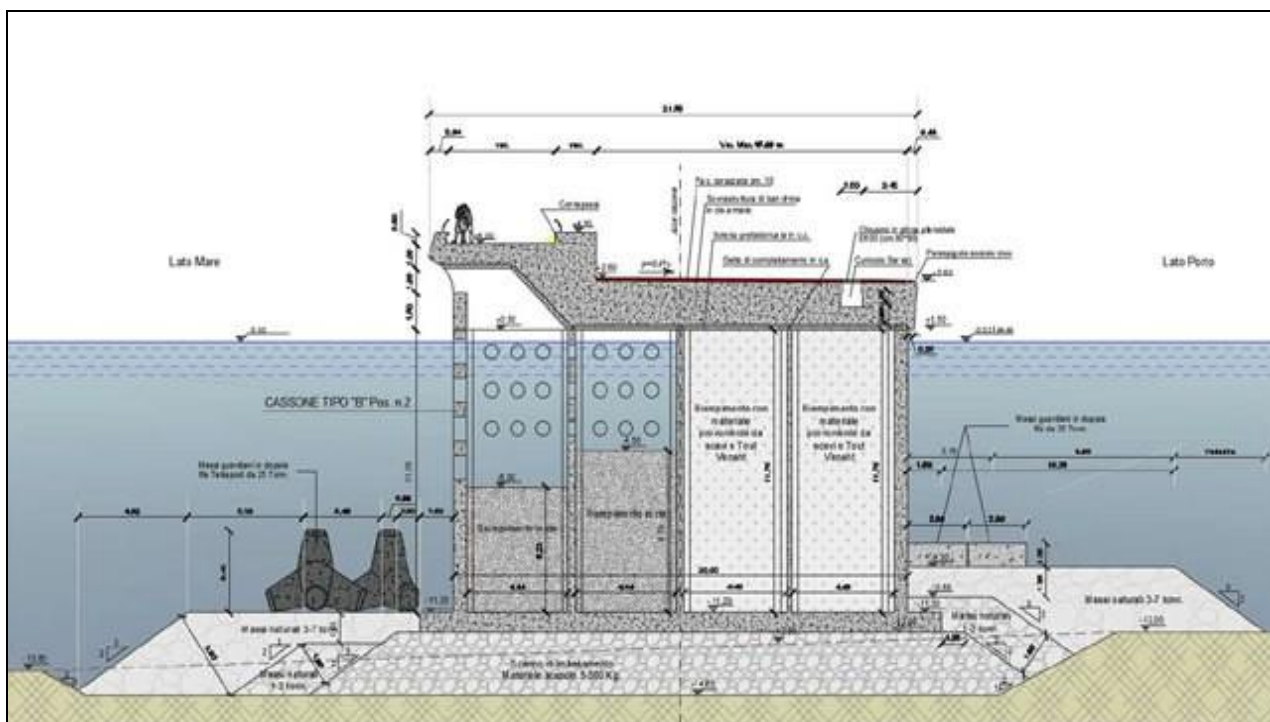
Sezione tipo B-B (Cassone tipo B)
